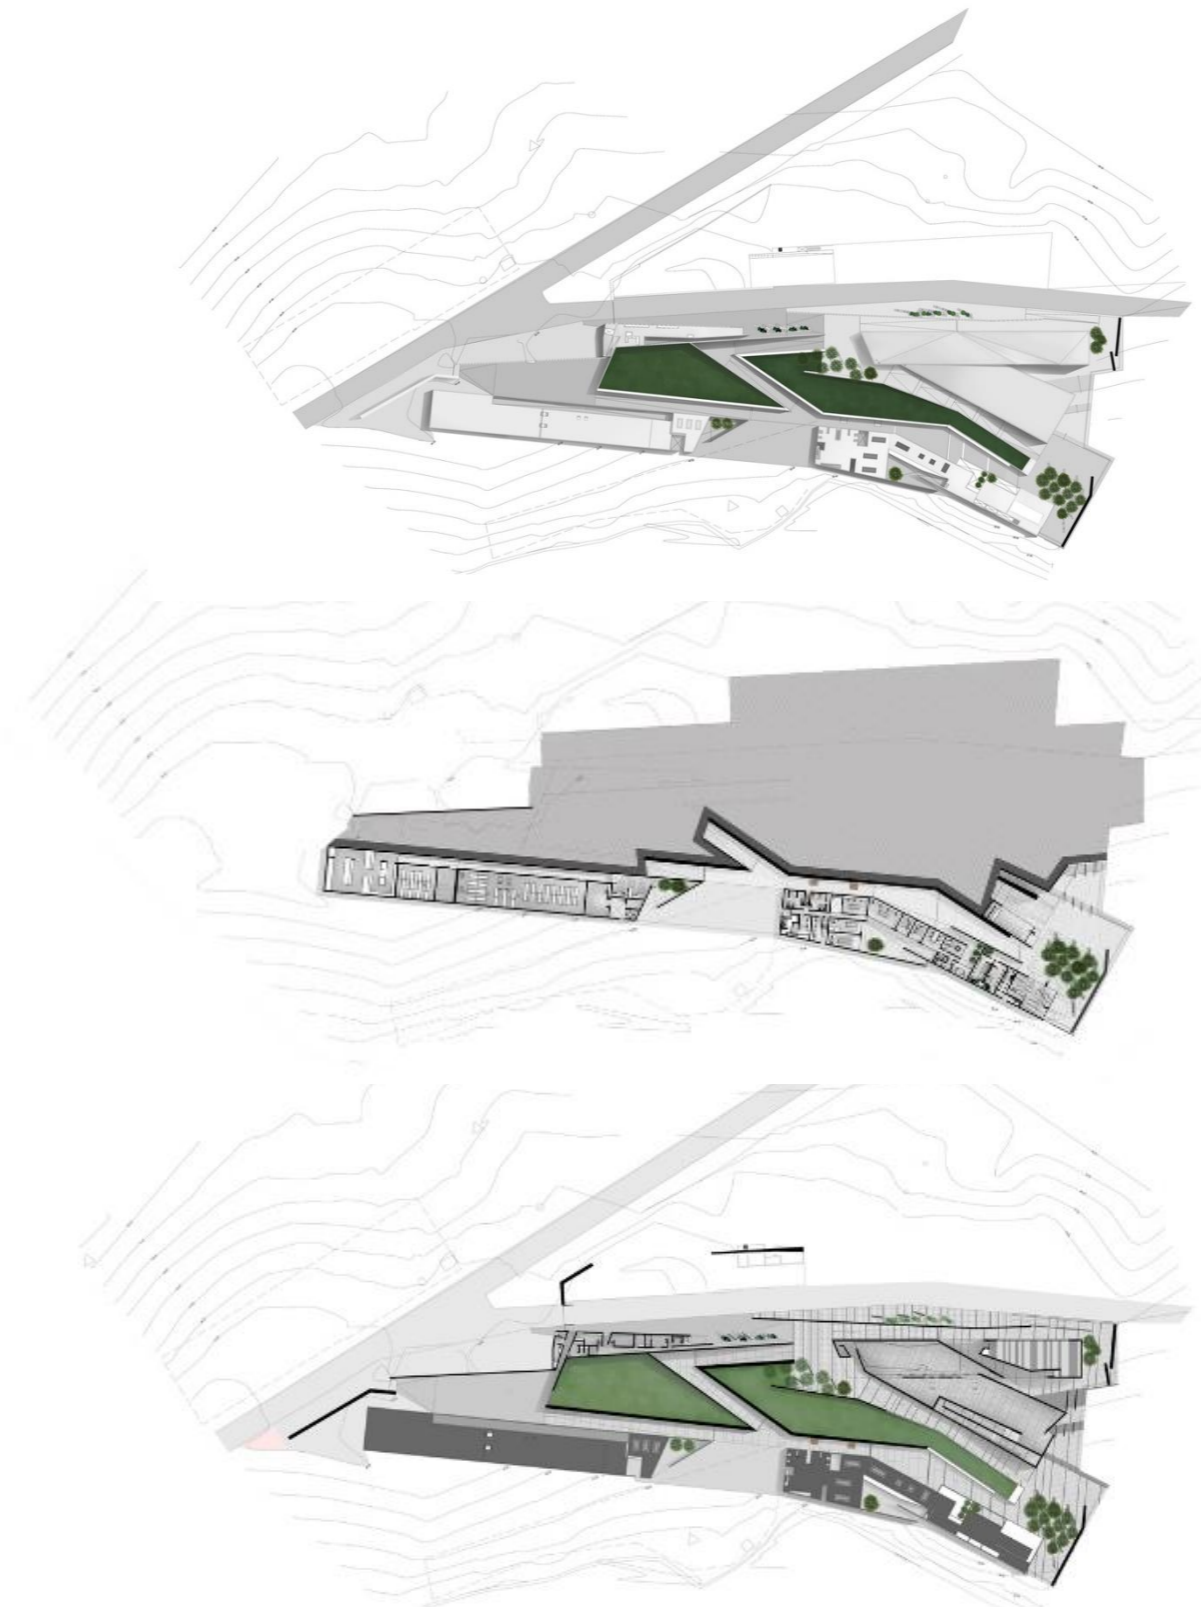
Plantas arquitectónicas Museo de sitio Pachacamac.
